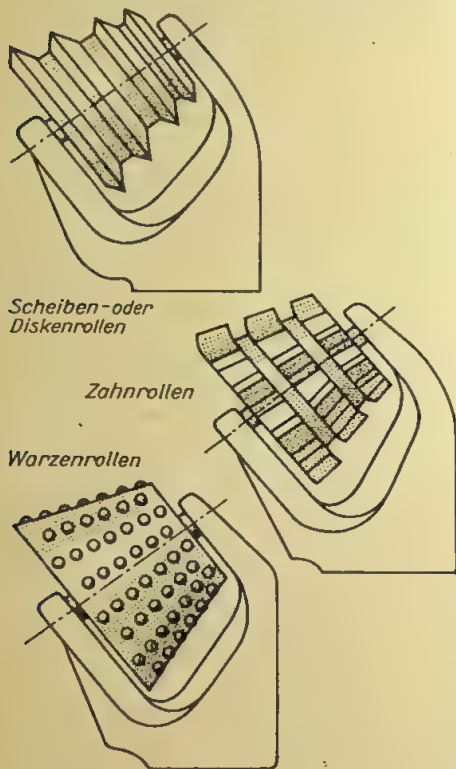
Rollenbohrwerkzeuge für Vortriebsmaschinen
